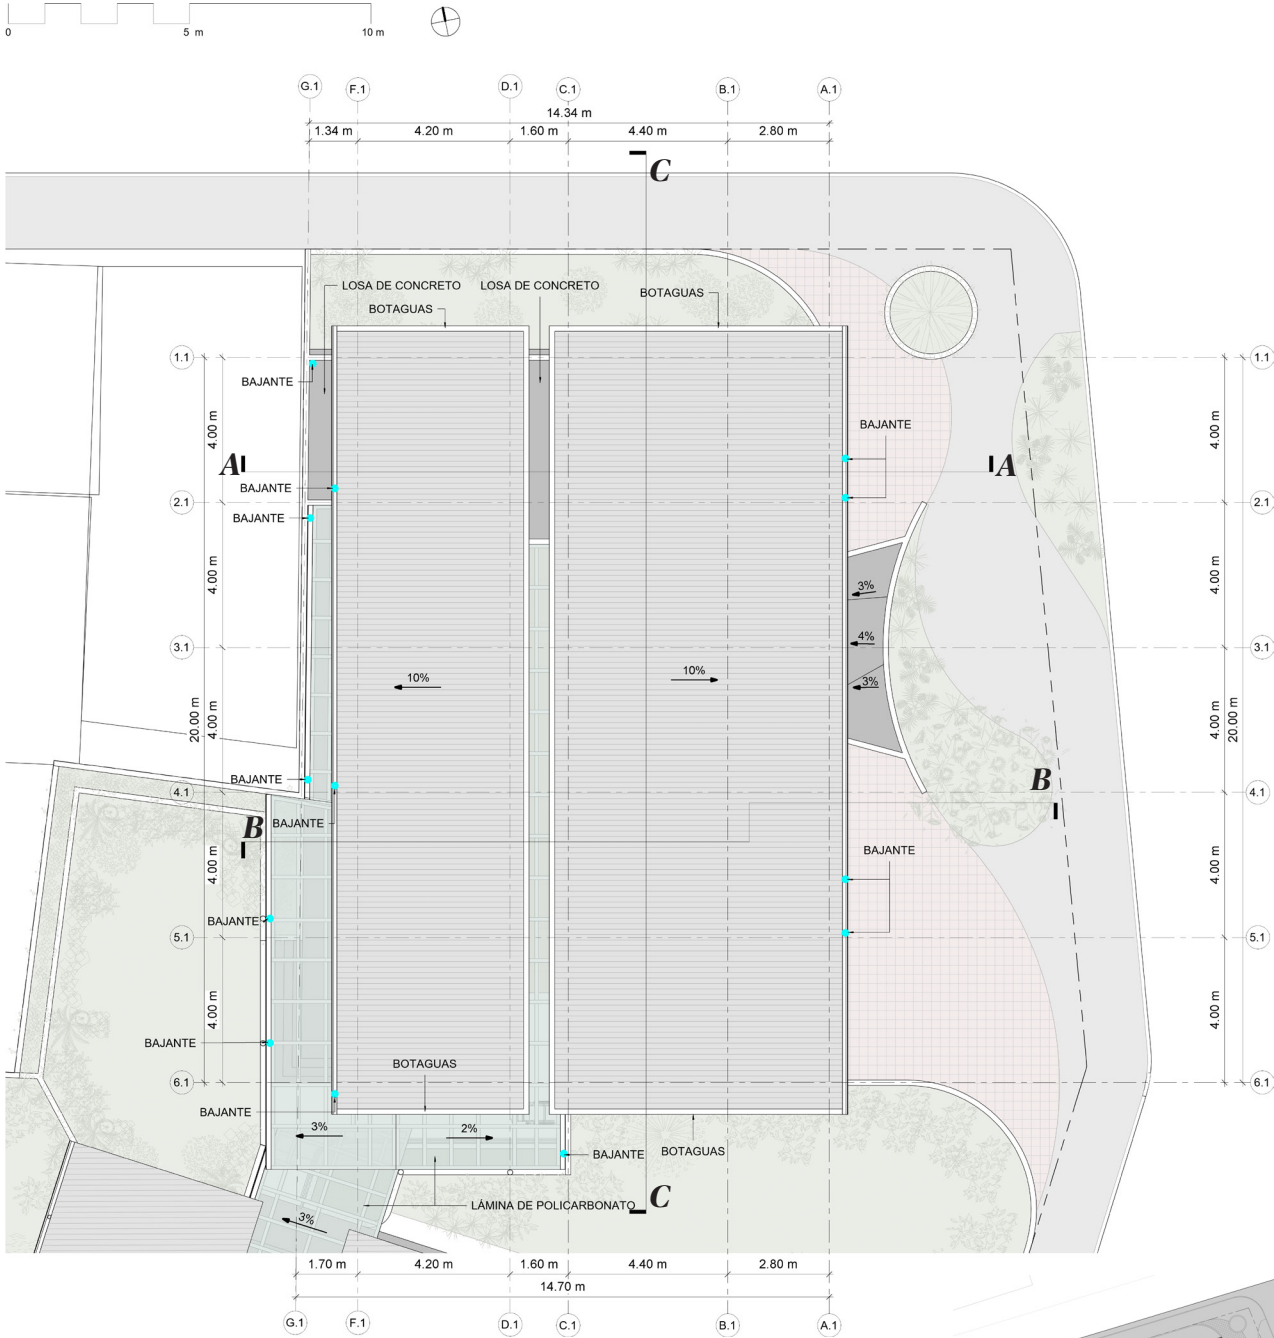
Planta de Cubiertas de Volumen 1. Fuente: Elaboración propia
